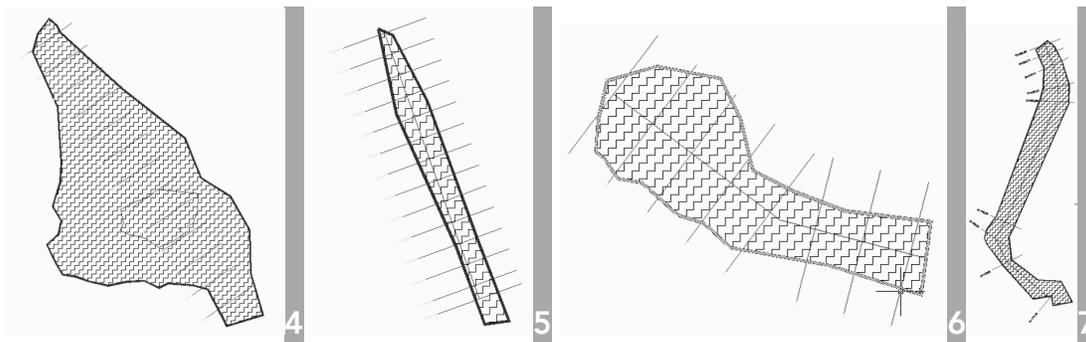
Vista en planta de cárcavas 4,5,6 y 7
